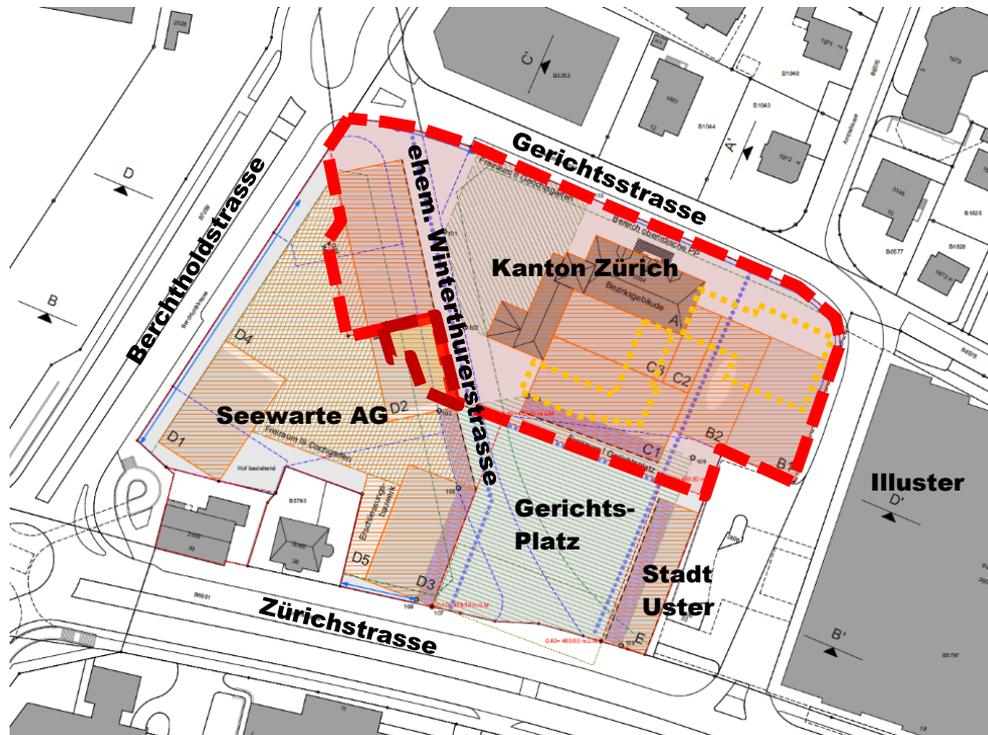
Gestaltungsplan Uster mit Planungserimeter. Erdgeschoss (rot gestrichelt) und Untergeschoss (dunkelrot gestrichelt), und Rückbau (gelb gepunktet), ohne Massstab, genordet
